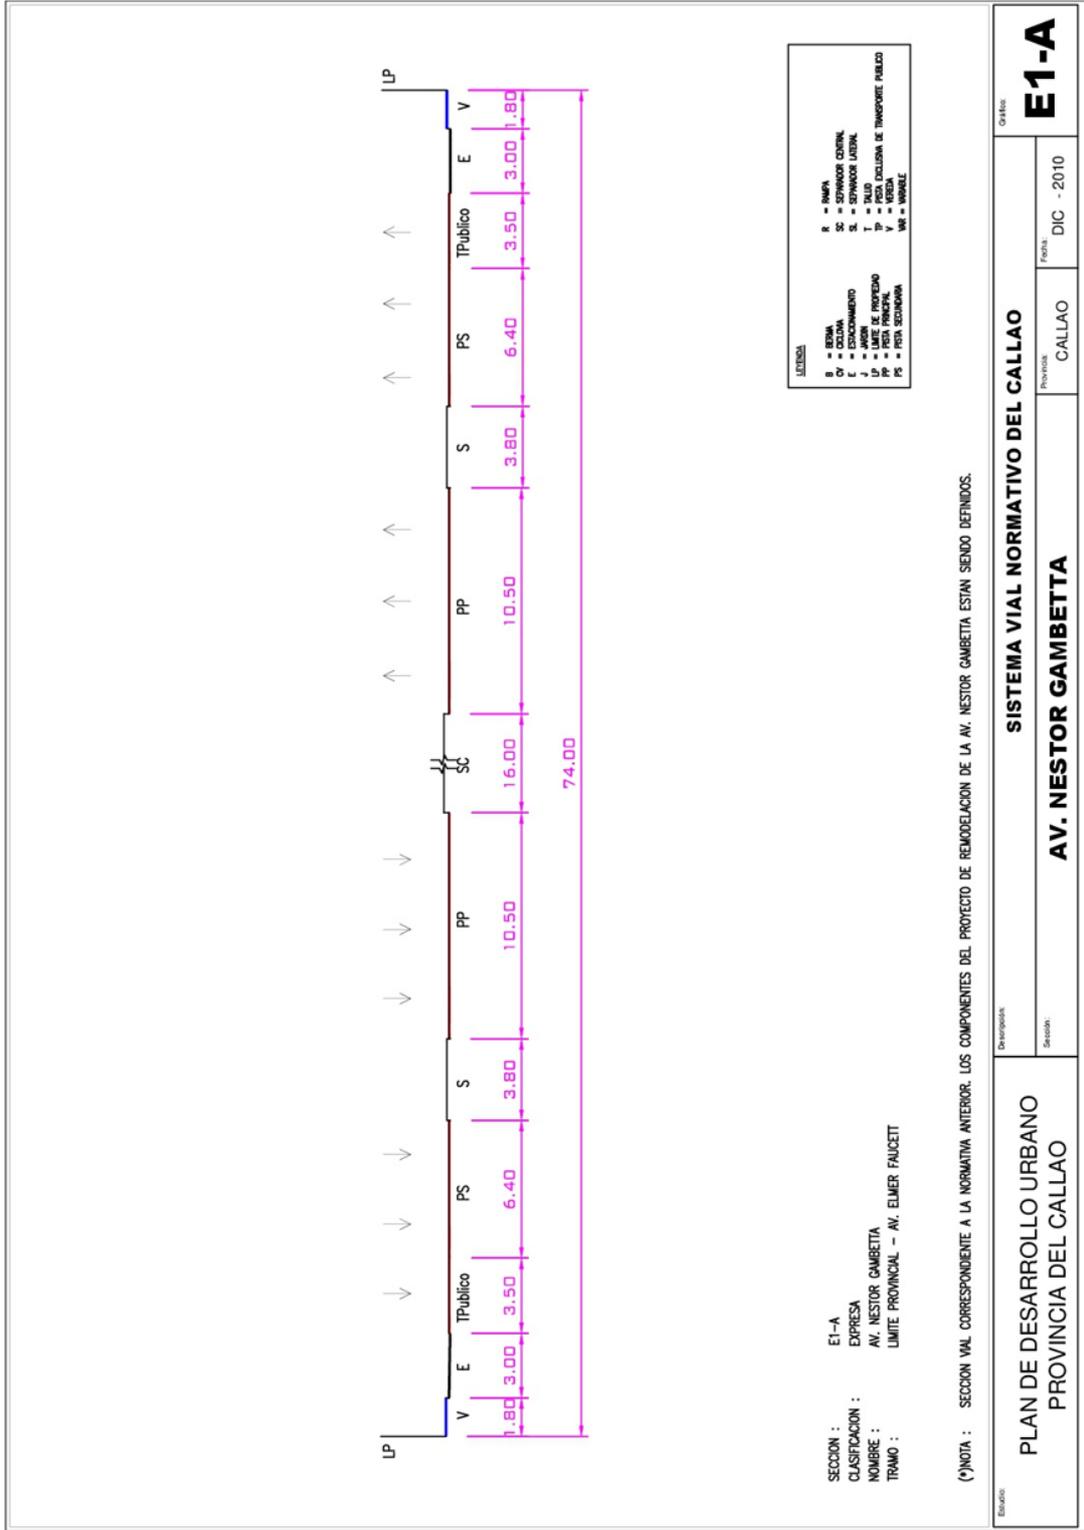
Sección Vial de Av. Néstor Gambetta – PDU Callao
